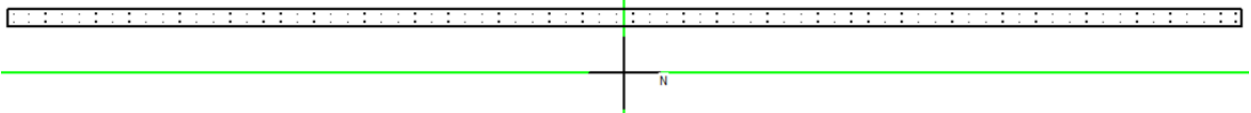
Geometria e armature di calcolo della sezione  $y=7.62m$
